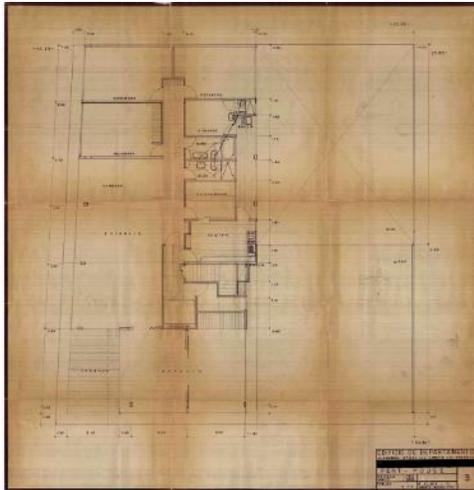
Plano planta pent-house del edificio ubicado en Emerson núm. 251, mayo 1959
